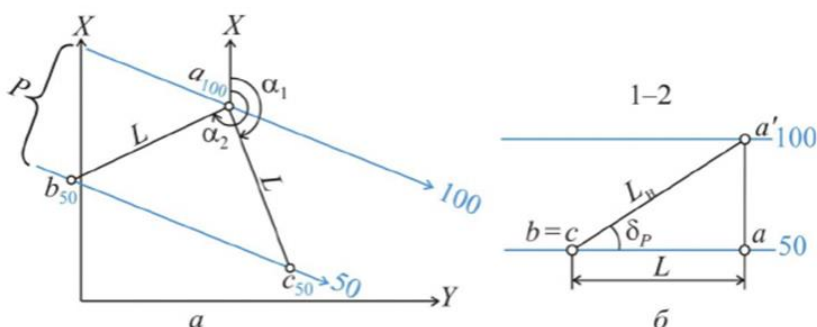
Определение длины и дирекционного угла наклонной выработки: а – план; б – разрез по оси выработки
